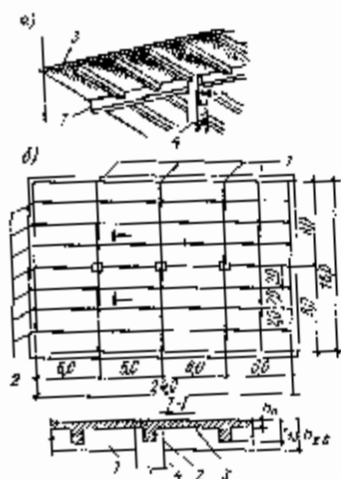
Железобетонное монолитное ребристое перекрытие: а – общий вид; б – схема плана перекрытия; 1 – главной балки; 2 – второстепенные балки; 3 – плита; 4 – колонна; $h_{п}$ – толщина плиты; $h_{в.б}$ – высота второстепенной балки; $h_{г.б}$ – высота главной балки.
